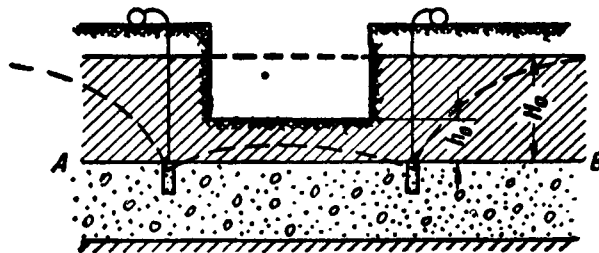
Схема проверки возможности прорыва дна котлована напорными водами
